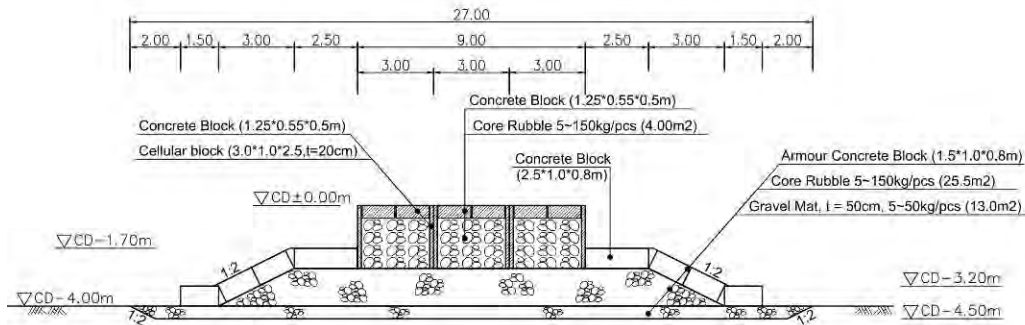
Mặt cắt ngang điển hình của đê chắn cát đề xuất – Tình huống B-1
